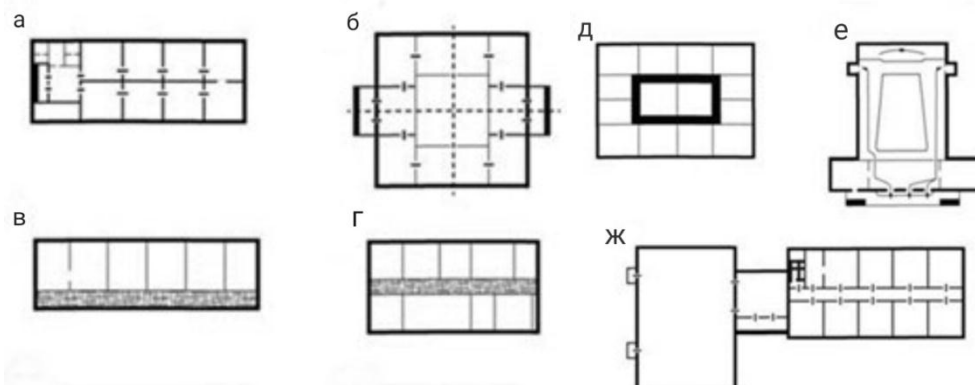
Об'ємно-планувальні схеми громадських будівель:
